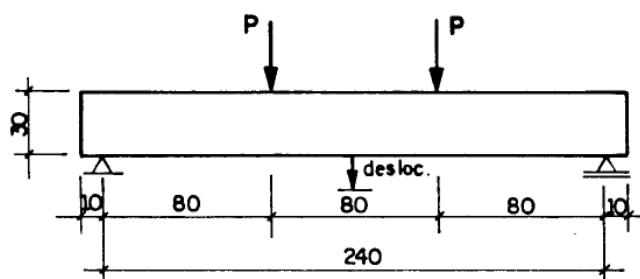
Esquema de carregamento das vigas (ÁLVARES, 1993)
